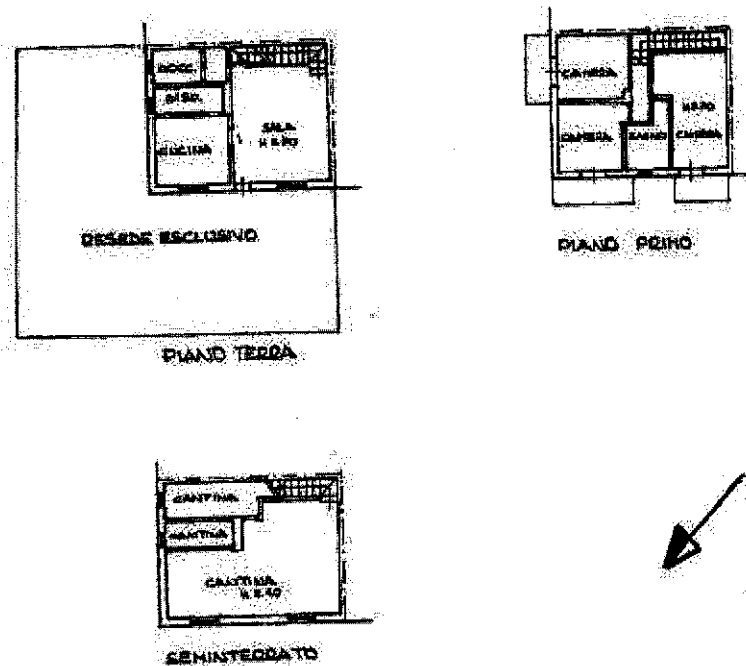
Estratto planimetria catastale del mapp.2254 sub.1 oggetto del presente lotto del 03/07/2002 (ultima in atti)
